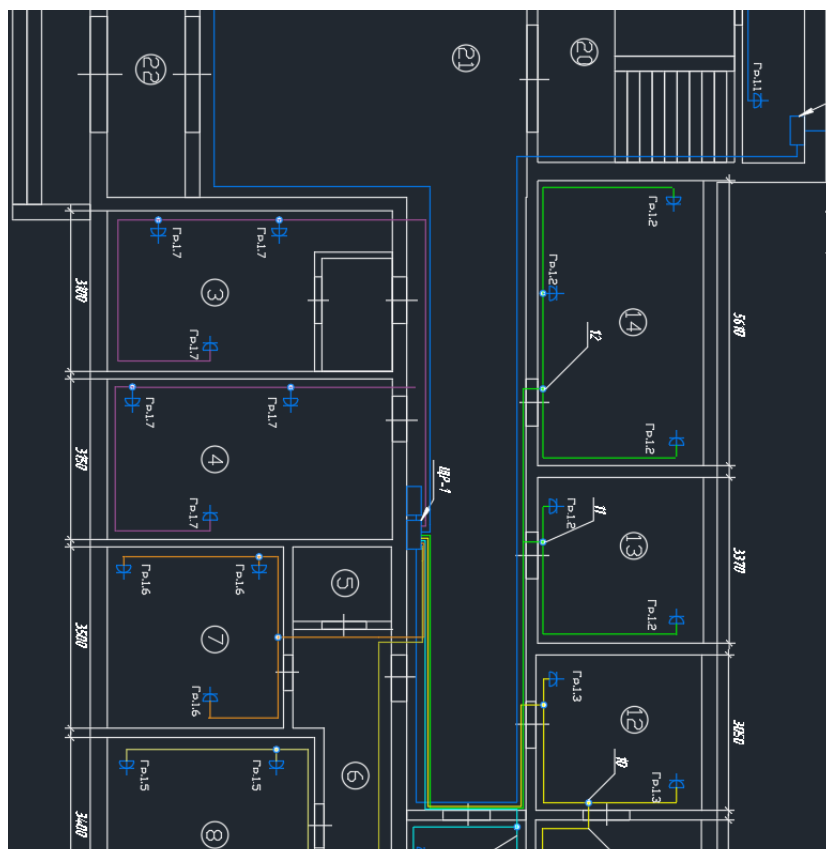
План силовой сети здания нежилых помещений ГУ СО ЦСО
